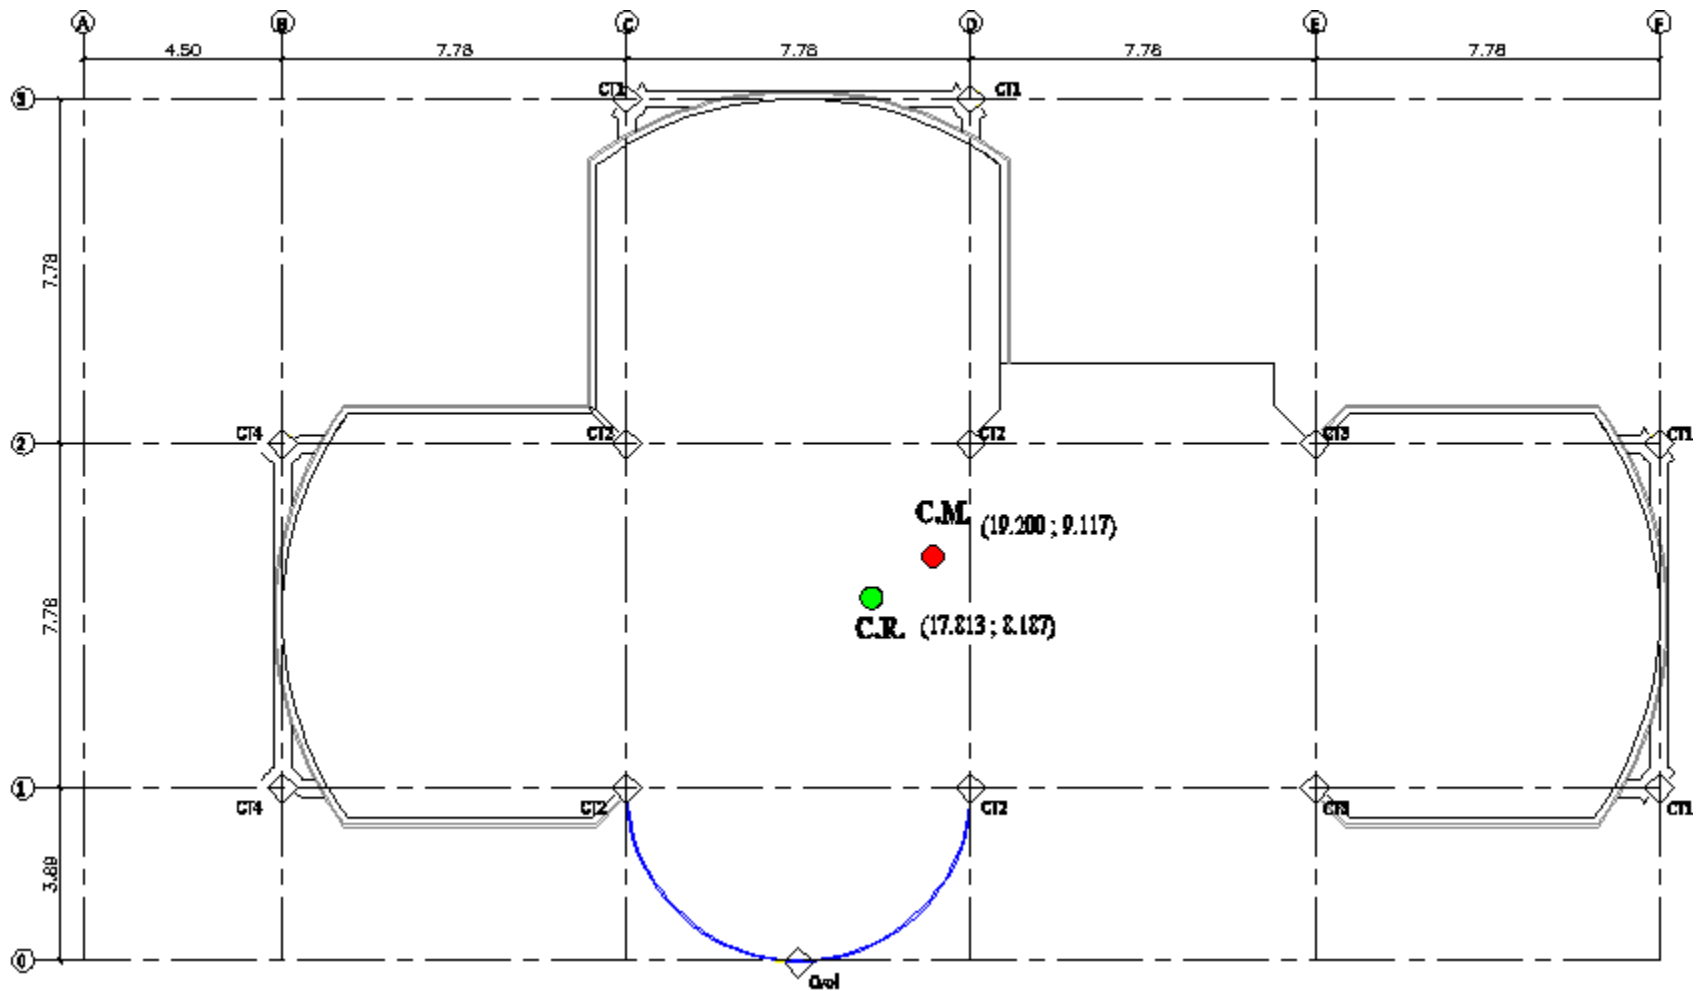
Centro de Masas y Rigidez de las Losas N+5.96, N+8.84
